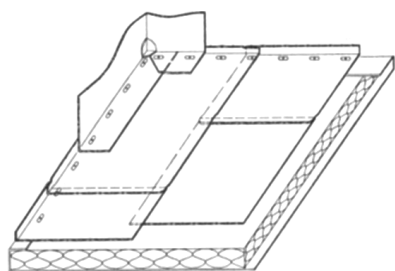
Fixation en pied de relevé par vis et plaquettes
